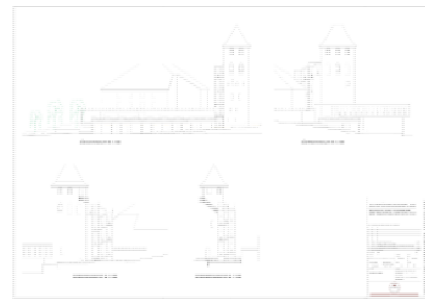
Winklern, Mautturm, Schnitt, Südostansicht
